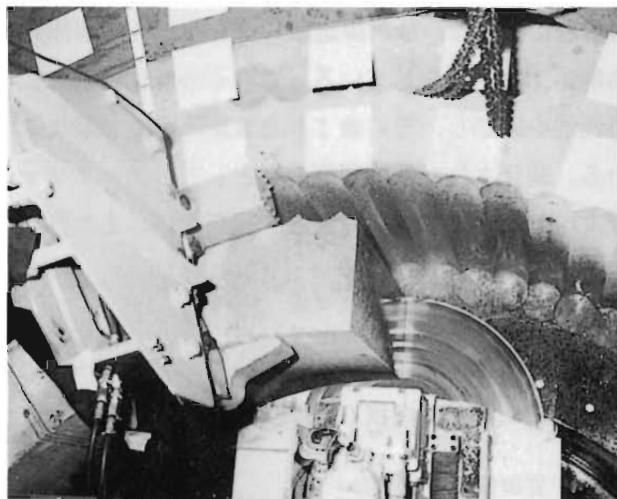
ダイヤモンドソーによるコンクリート構造物機械的切断試験装置による試験状況
